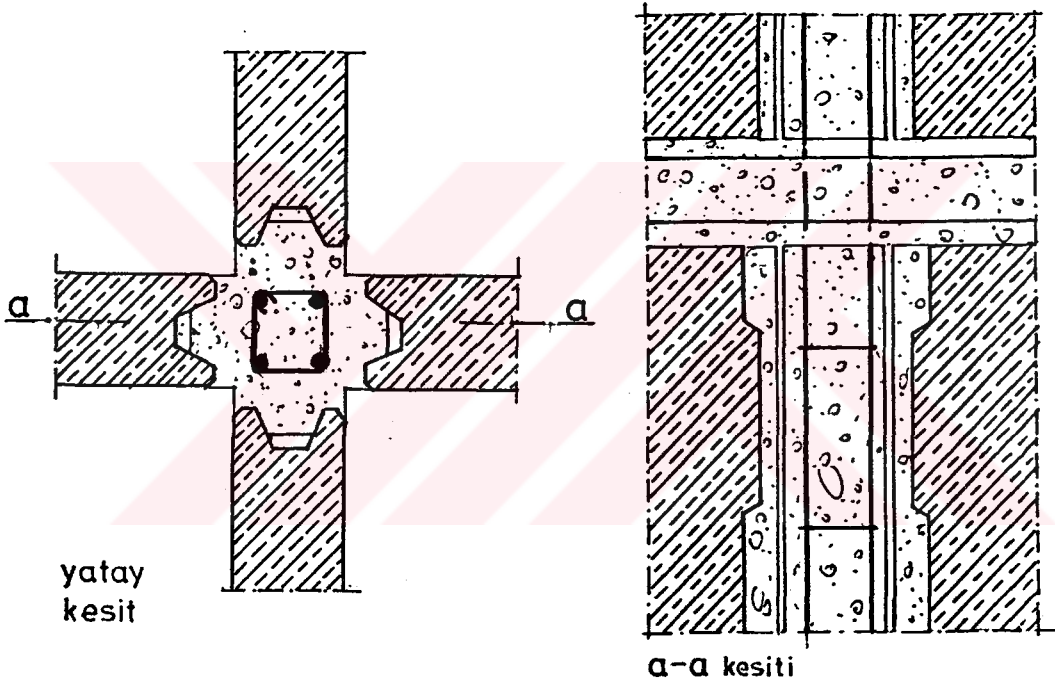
Sadece yerinde dökme betonla yapılan düşey birleşim derz [20, S.265].
